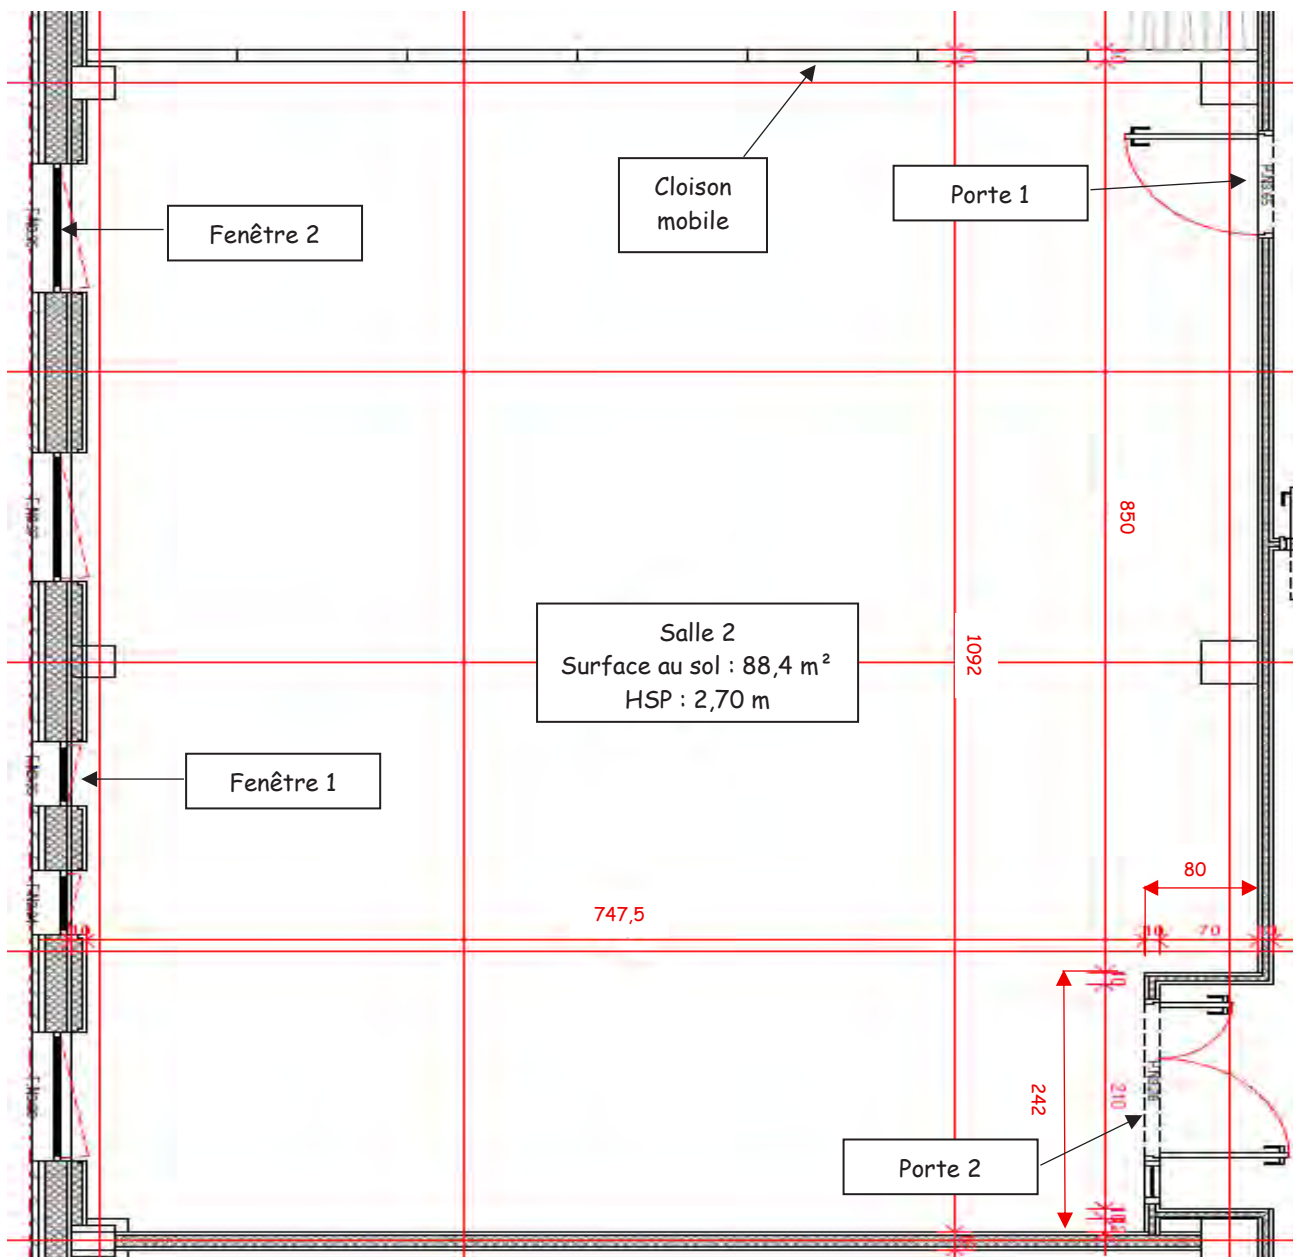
Vue en plan cotée de la salle 2 (cotation en cm) – pas d'échelle
